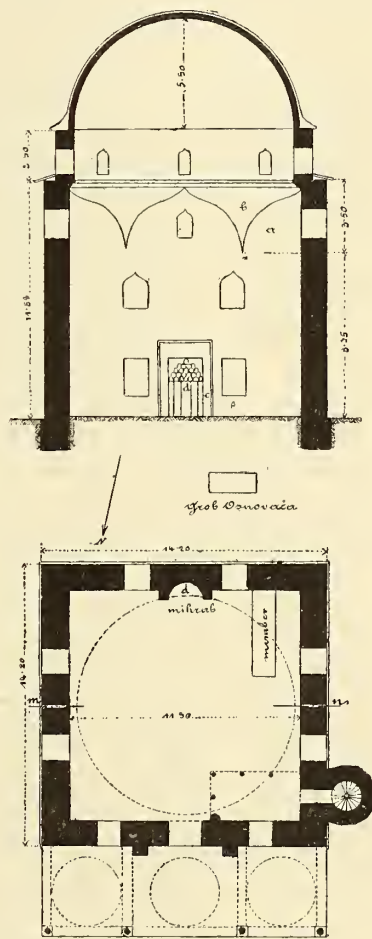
Aufriss und Grundriss der Aladža-Džamija in Foča.
